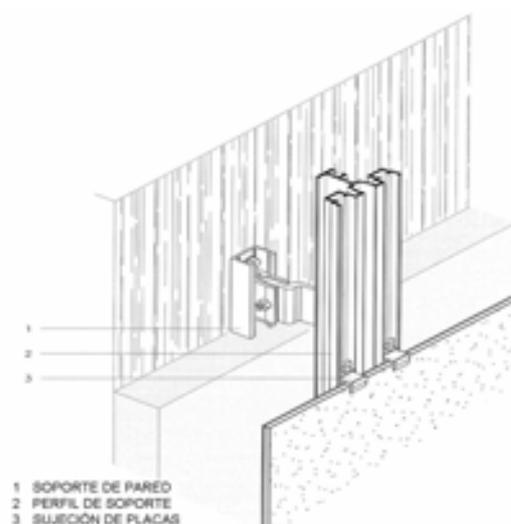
Detalles de la estructura y los fijadores de la Fachada Fotovoltaica Verde de Tübingen (Alemania).
